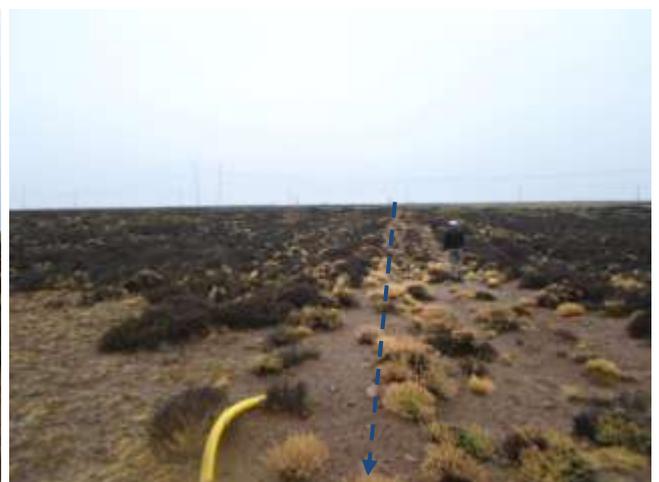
Emplazamiento por picada existente. Foto en dirección E.
